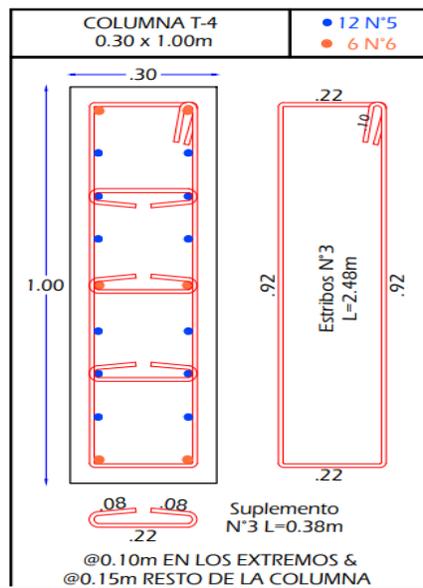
Despiece transversal y longitudinal de columna T4plano Wiedii
